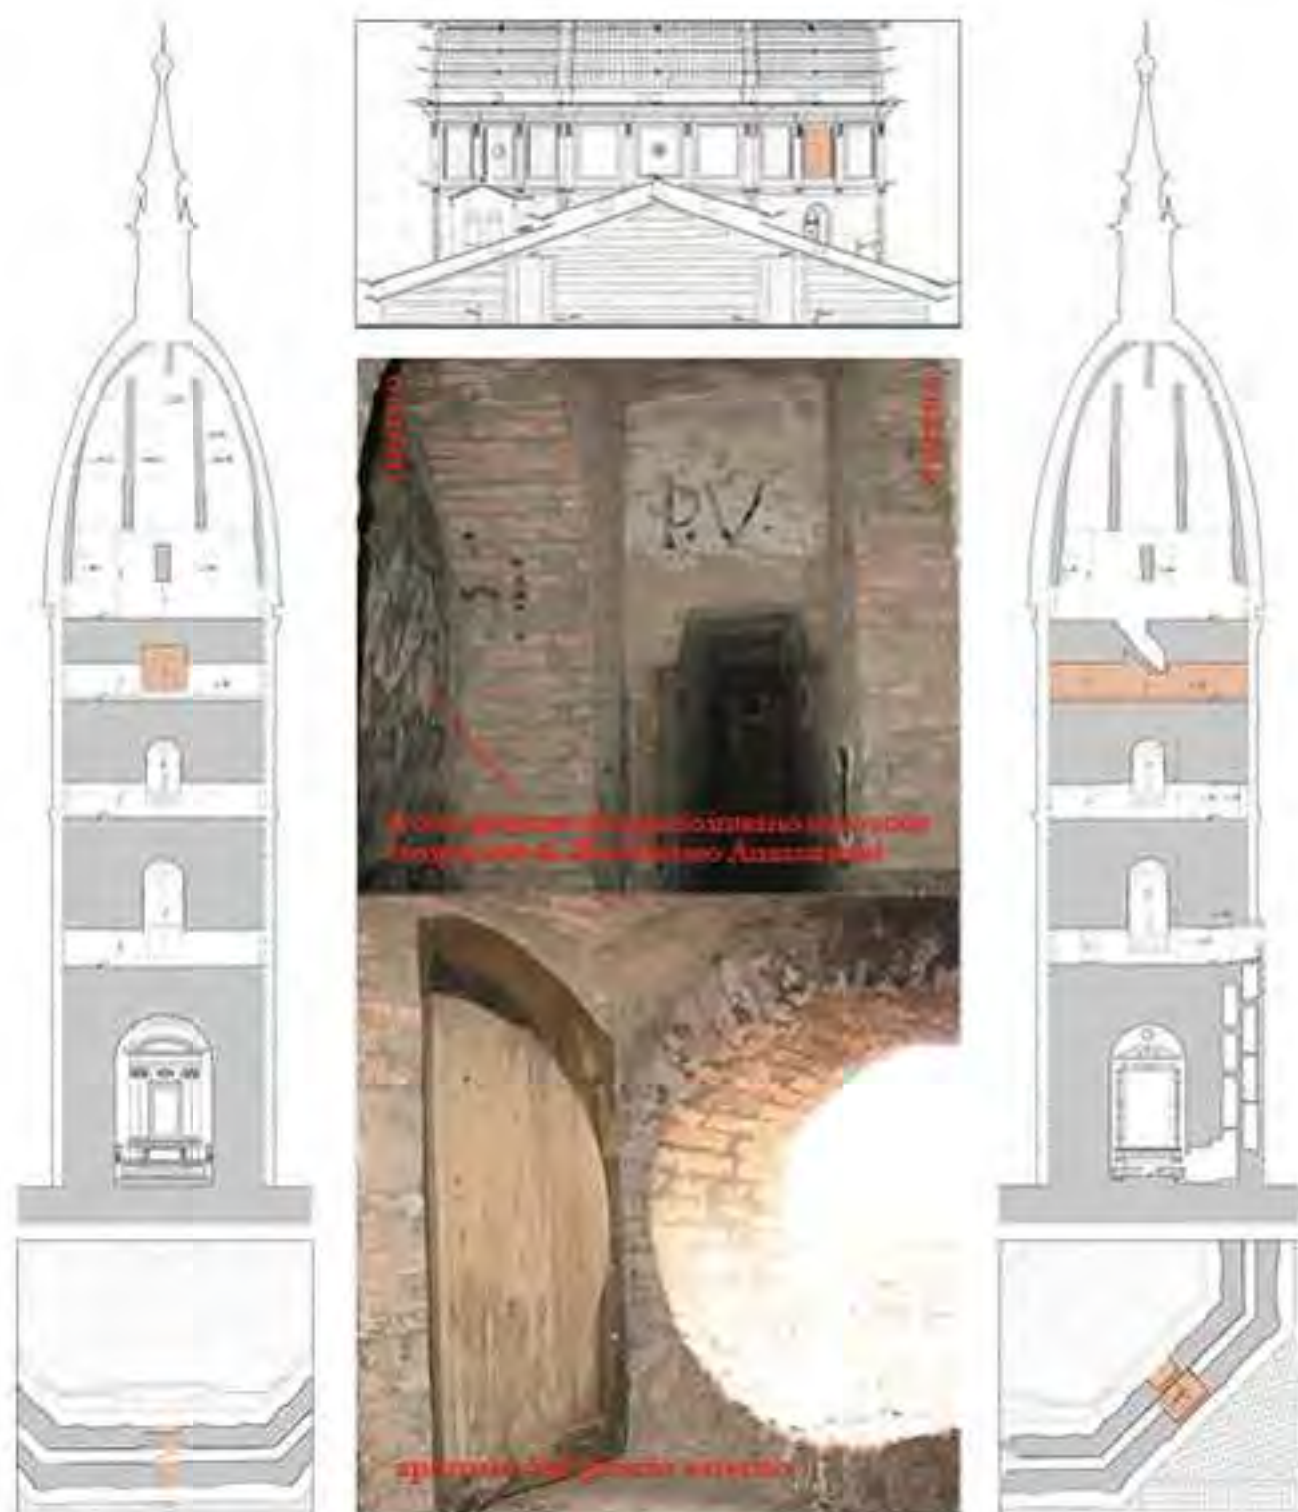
A sinistra, vela n. 1 nel prospetto sezione dell'estradosso del guscio interno; a destra, vela n. 8 nel prospetto sezione dell'estradosso del guscio interno; al centro: in alto, il prospetto su via della Madonna; in basso, il dettaglio delle finestre [36]
